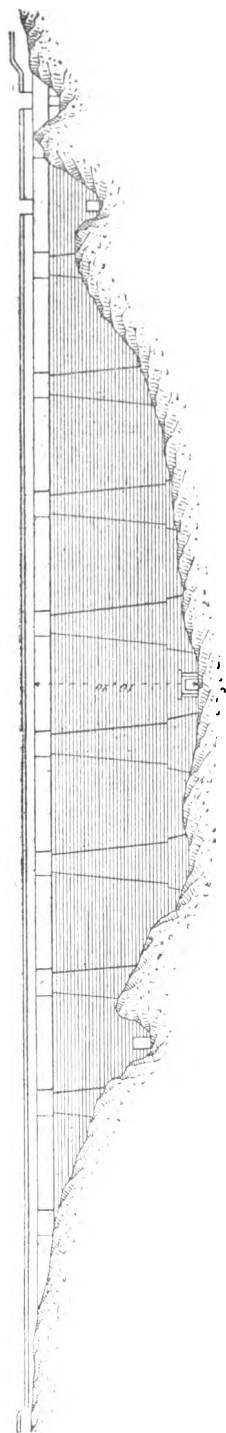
Élévation du barrage du Lamy (Vue d'aval).
